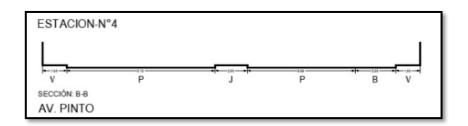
Corte B-B Sección Vial de la Av. Gustavo Pinto Fuente: Elaboración Propia
